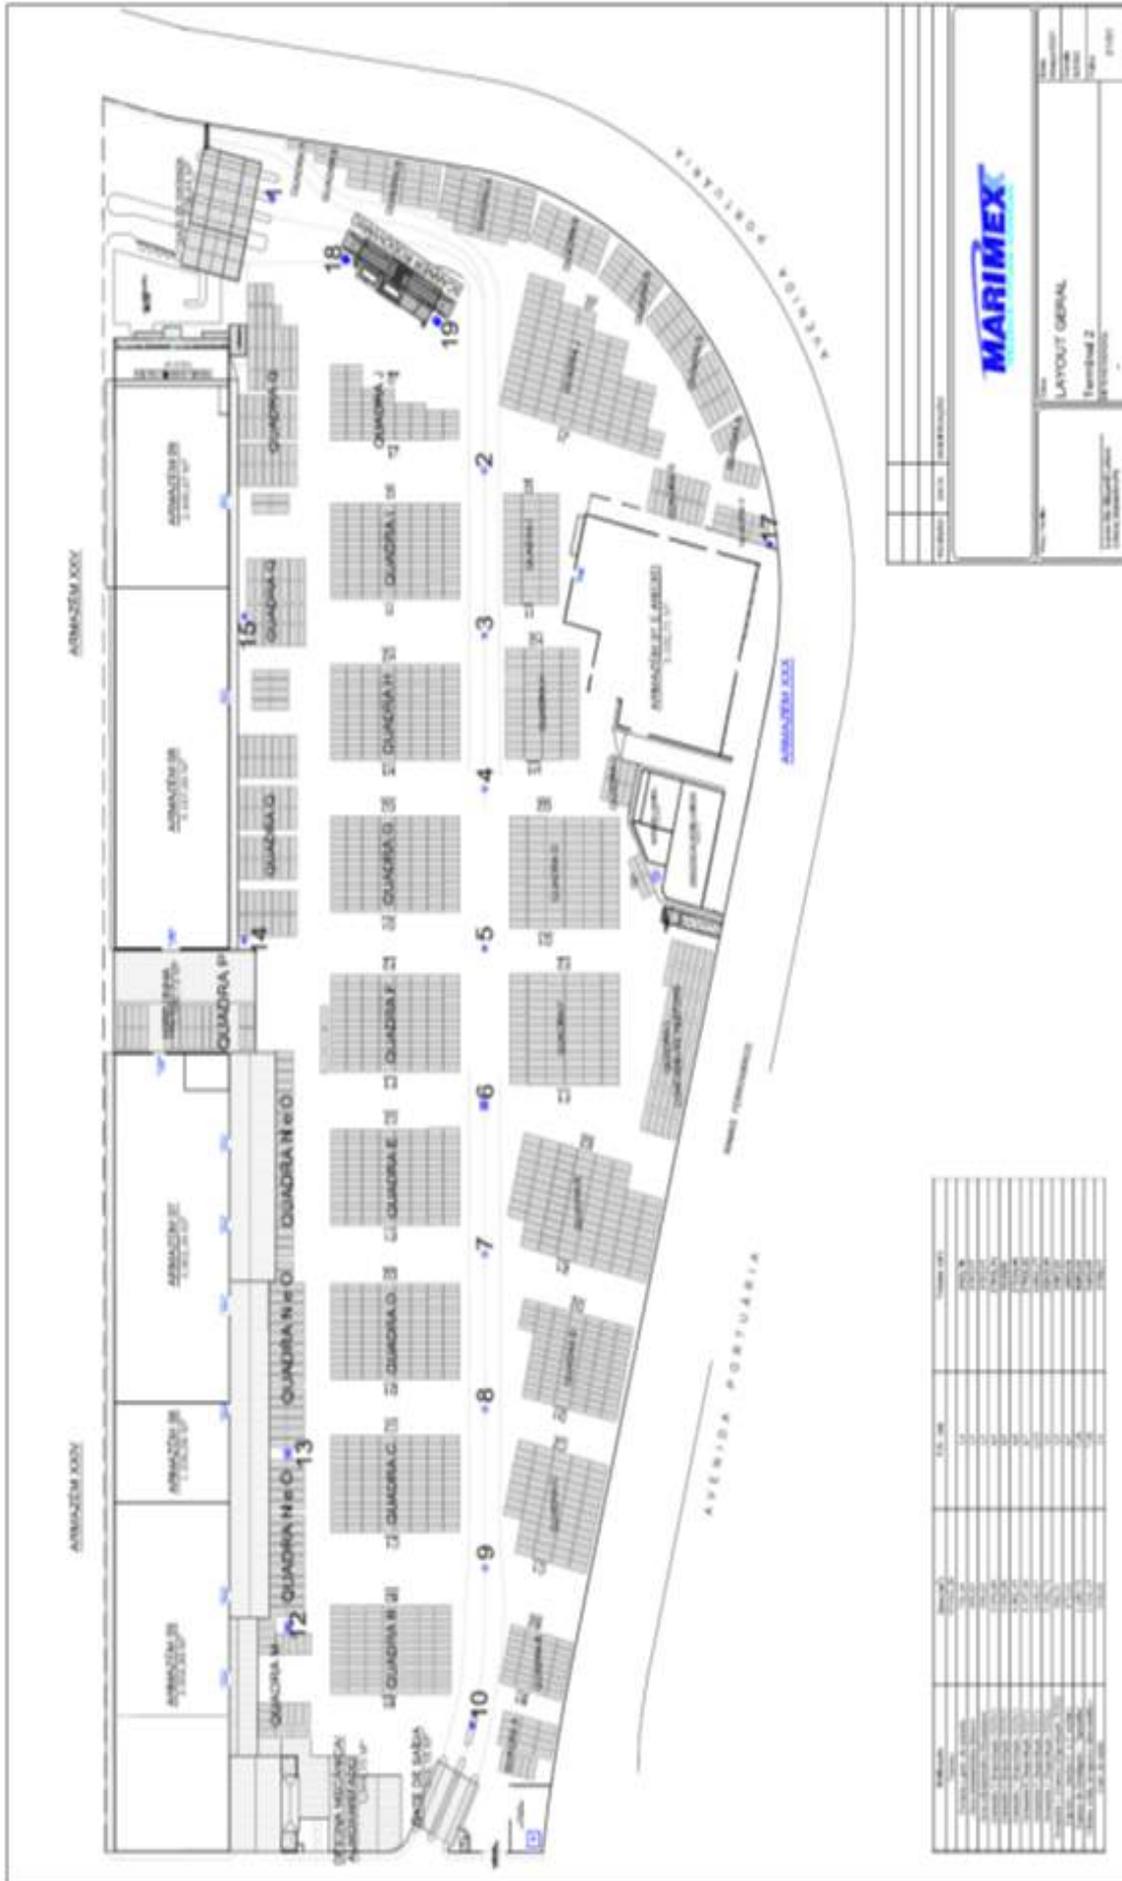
Planta com quadro de Volumetria do Terminal (Anexo 1).
